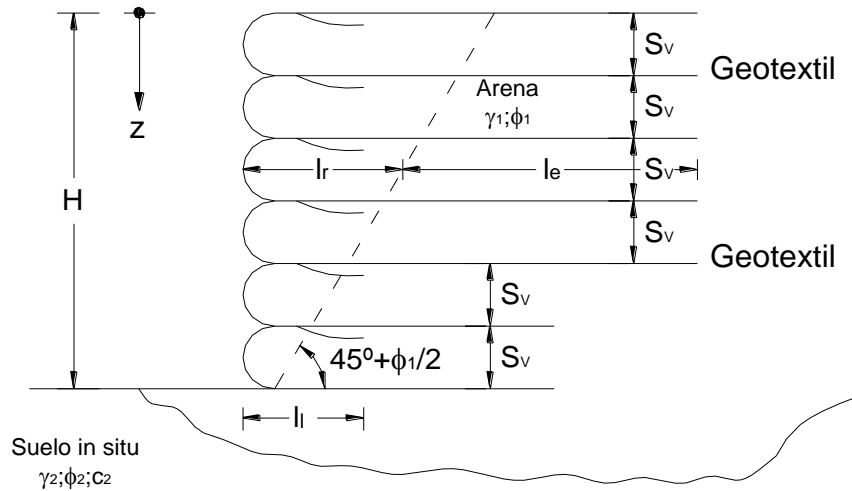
Muro de retención con refuerzo geotextil (Tomado de Principio de Ingeniería de Cimentaciones de Braja M Das Pag 439)
